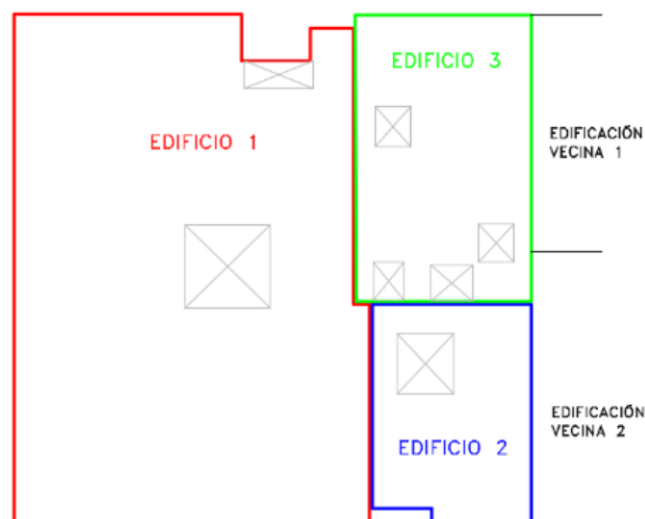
Vista en planta del Hospital Carlos Carmona Montoya.
